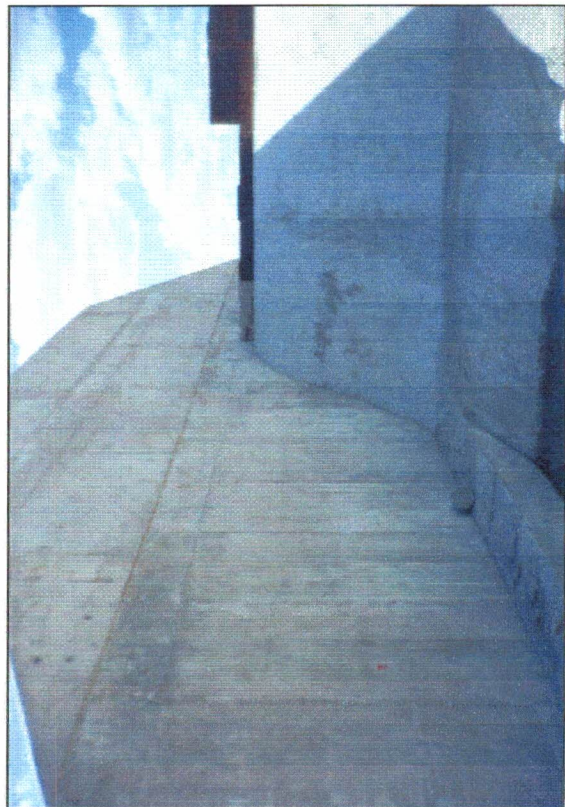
Encontro entre o bloco do perfil "creager" e o muro de contenção estaca 82.
